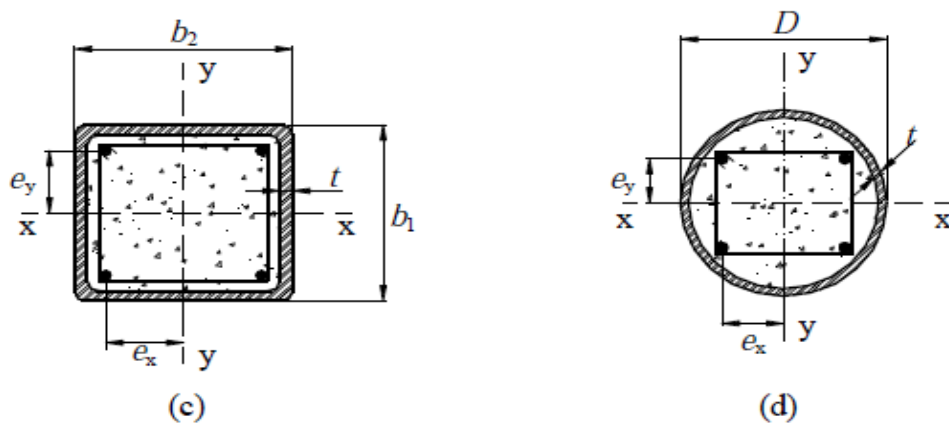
Tipos de seções transversais de pilares mistos preenchidos
